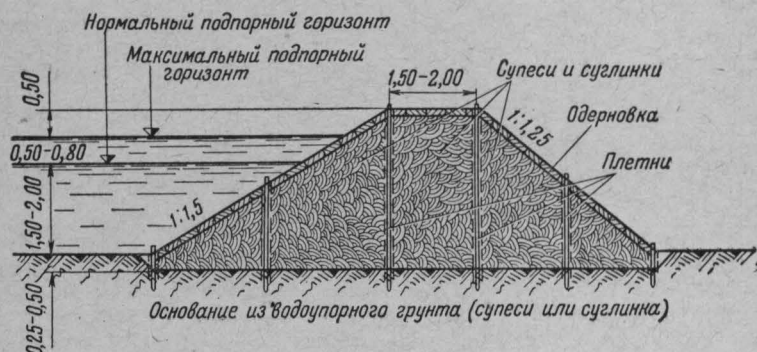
Поперечное сечение земляной плотины из водоупорных грунтов с продольными плетнями
